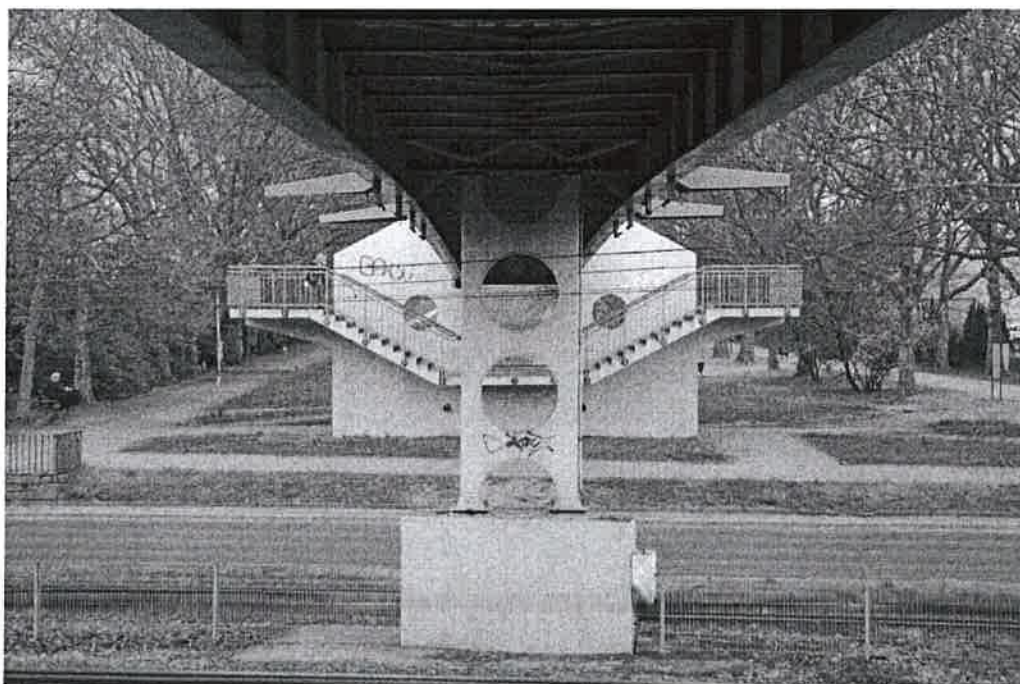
Widok od spodu konstrukcji nośnej kładki
